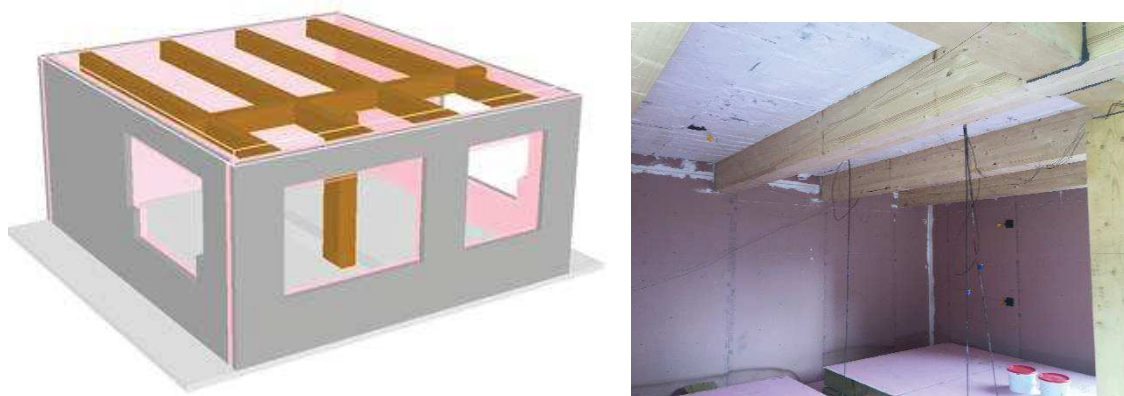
Schéma et prise de vue de la configuration Poteau/Poutres LC (Essai 3)
